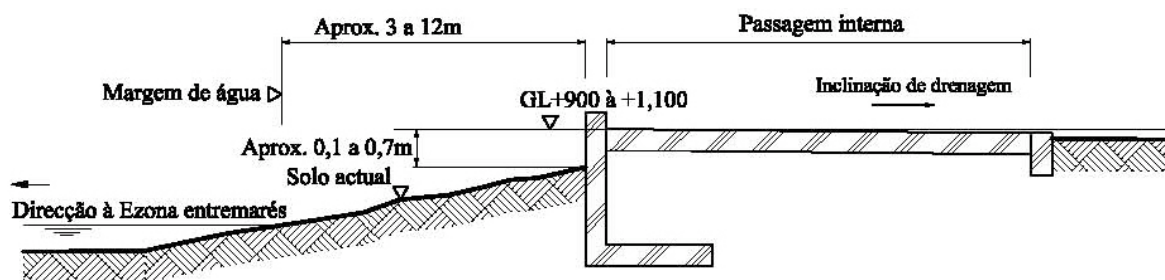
Plano da Passagem Interna e dos Muros de Suporte no Lado da Zona Entremarés
